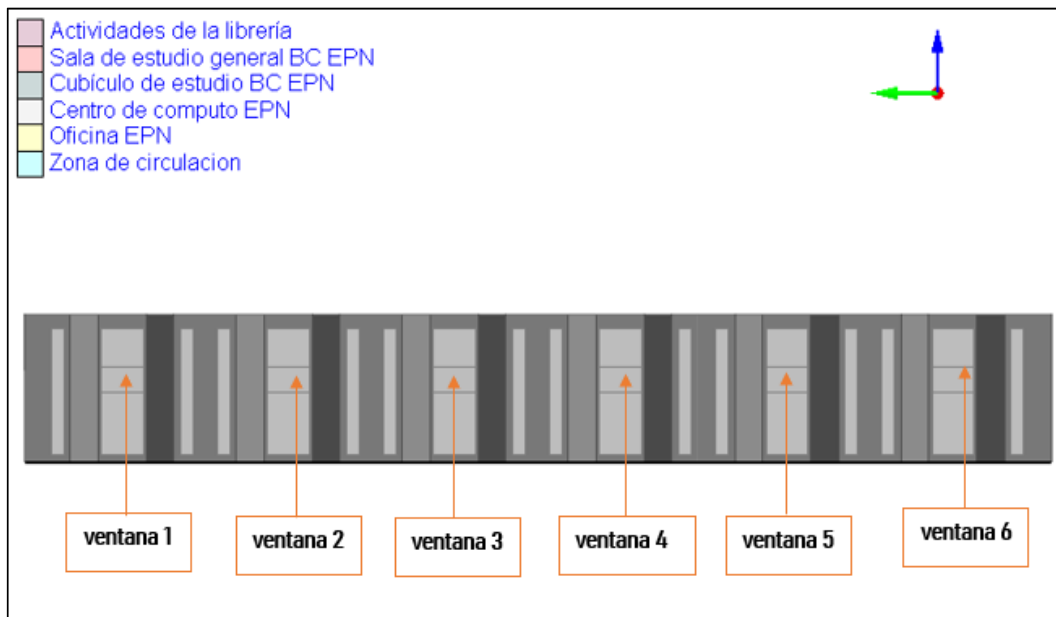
6. Fachada exterior principal de la Biblioteca Central.
